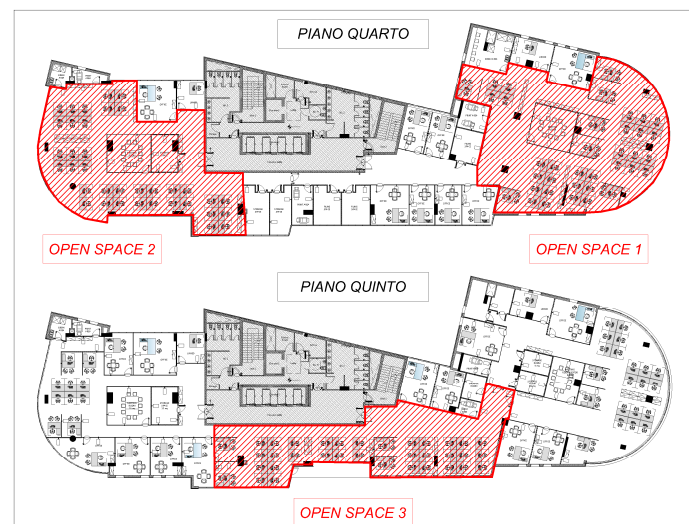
Ubicazione planimetrica degli open space oggetto di studio.
